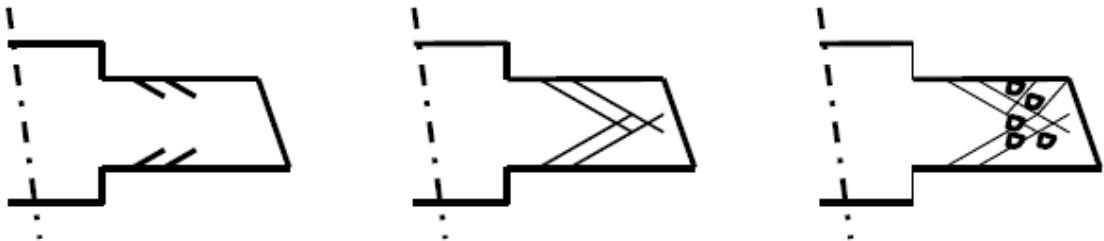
absence d'armature transversale, le cisaillement alterné détruit-les sections.
